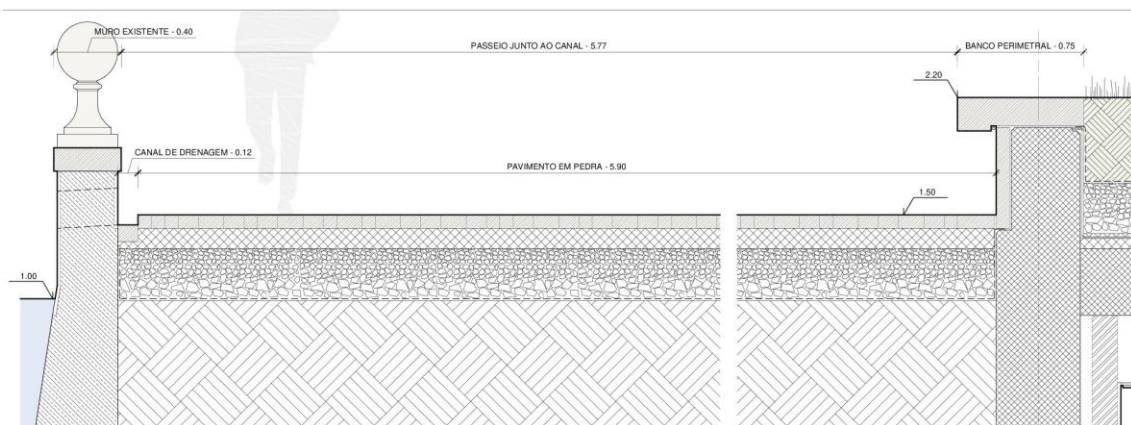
Desenho de pormenorização da área pedonal junto ao canal.
